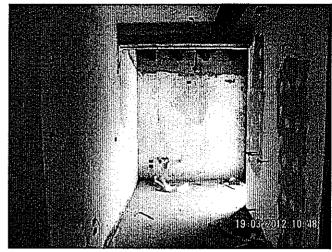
Stanza 8- Vista parete lato stanza 9 e porta accesso
